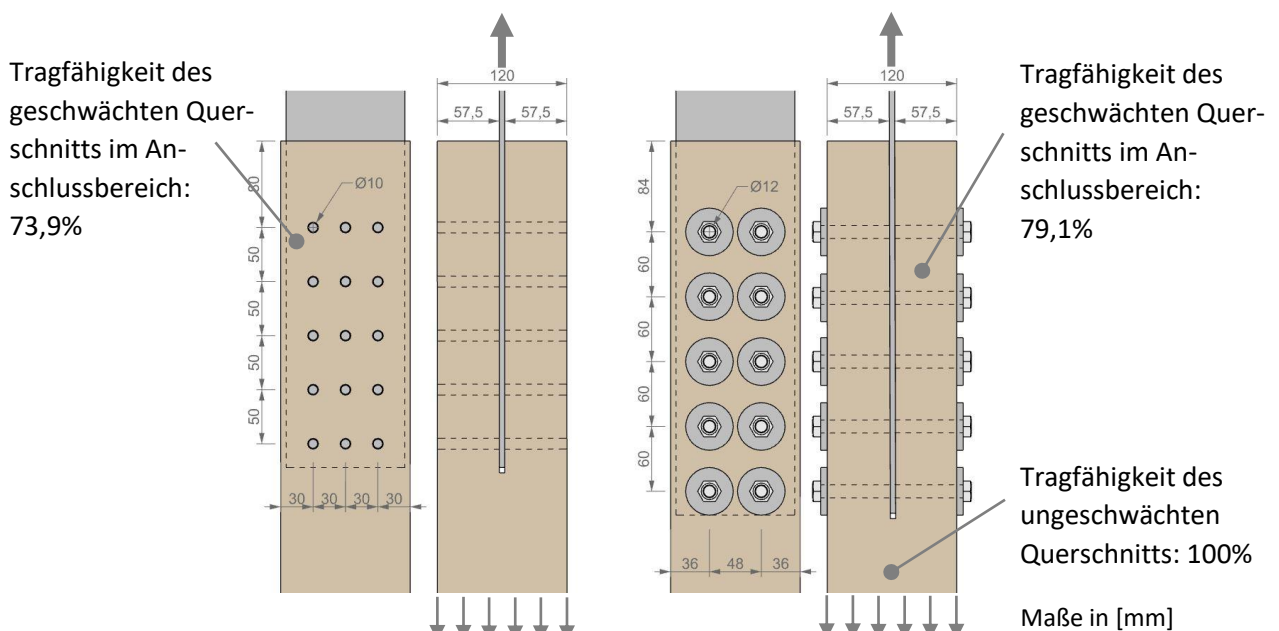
Anschlussausführung mit Stabdübeln (links) und Passbolzen (rechts)
